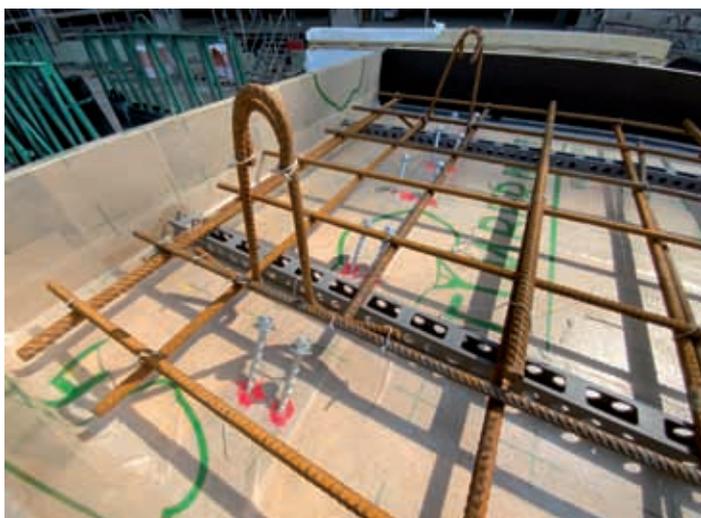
Montierte Verbundschrauben und Bewehrung
